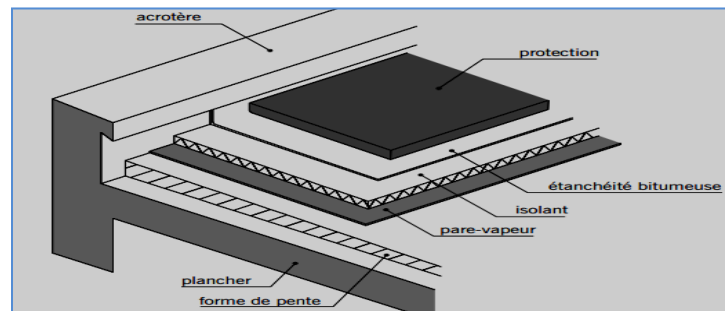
Différents couches constitutifs du plancher terrasse inaccessible.
